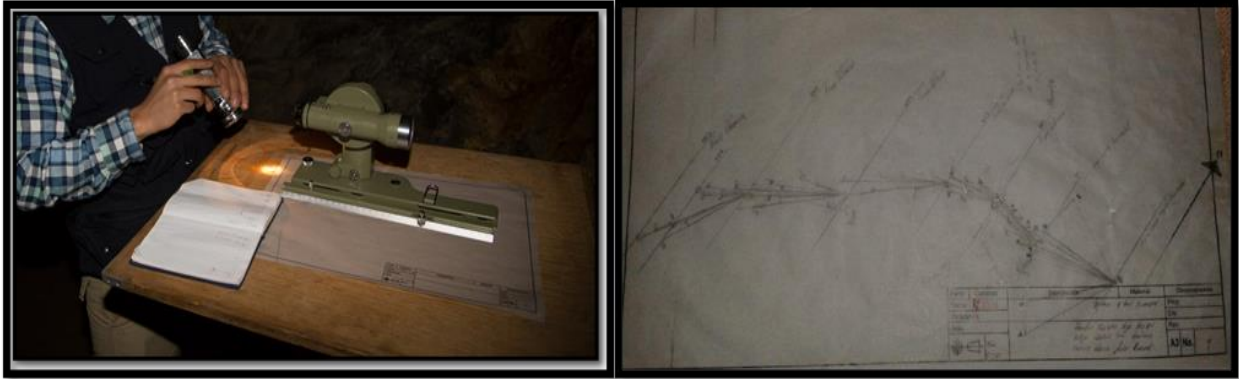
Plancheta y hoja de dibujo, foto tomada al interior de la mina Guadalupe, durante el levantamiento.
